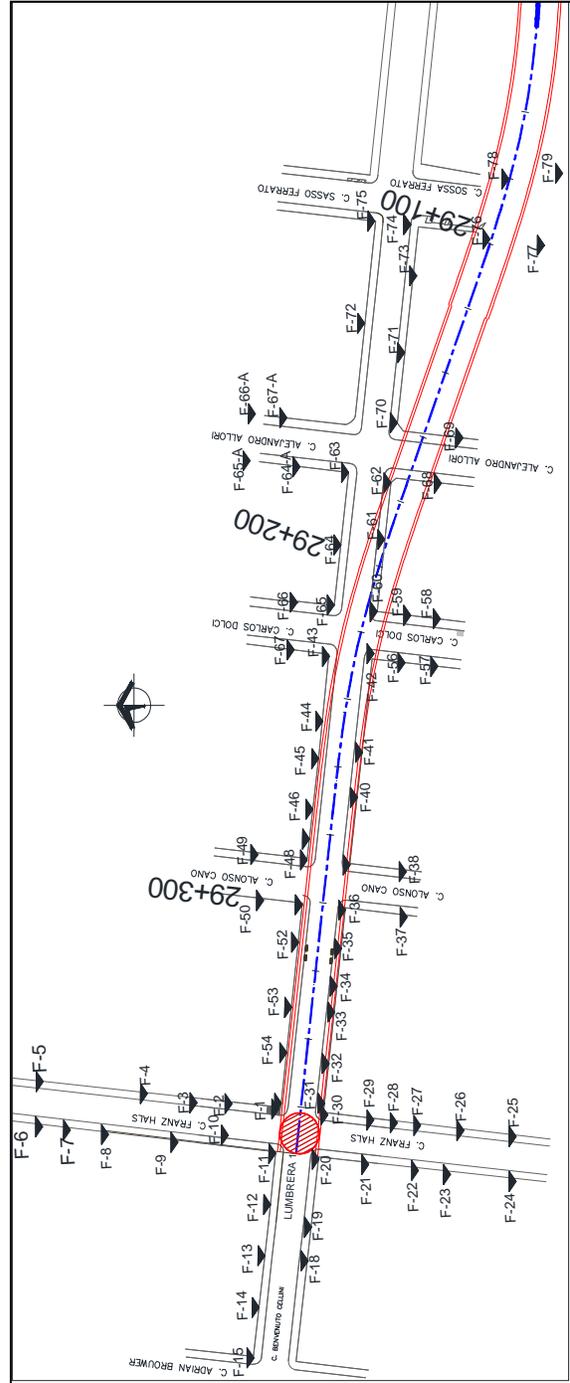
Vista en planta de la colocación de las niveletas del tramo Lumbra 1-Periférico Sur
